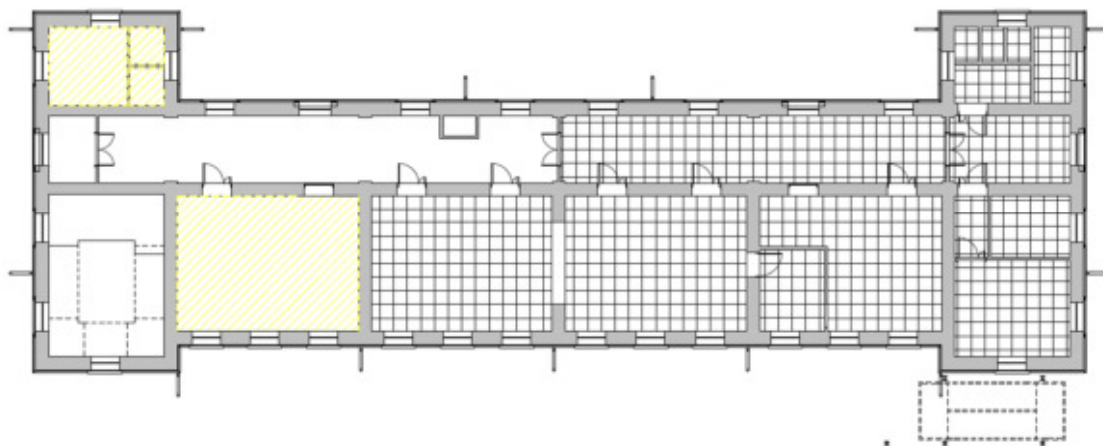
Pianta piano rialzato – Indicazione controsoffitti da sostituire
